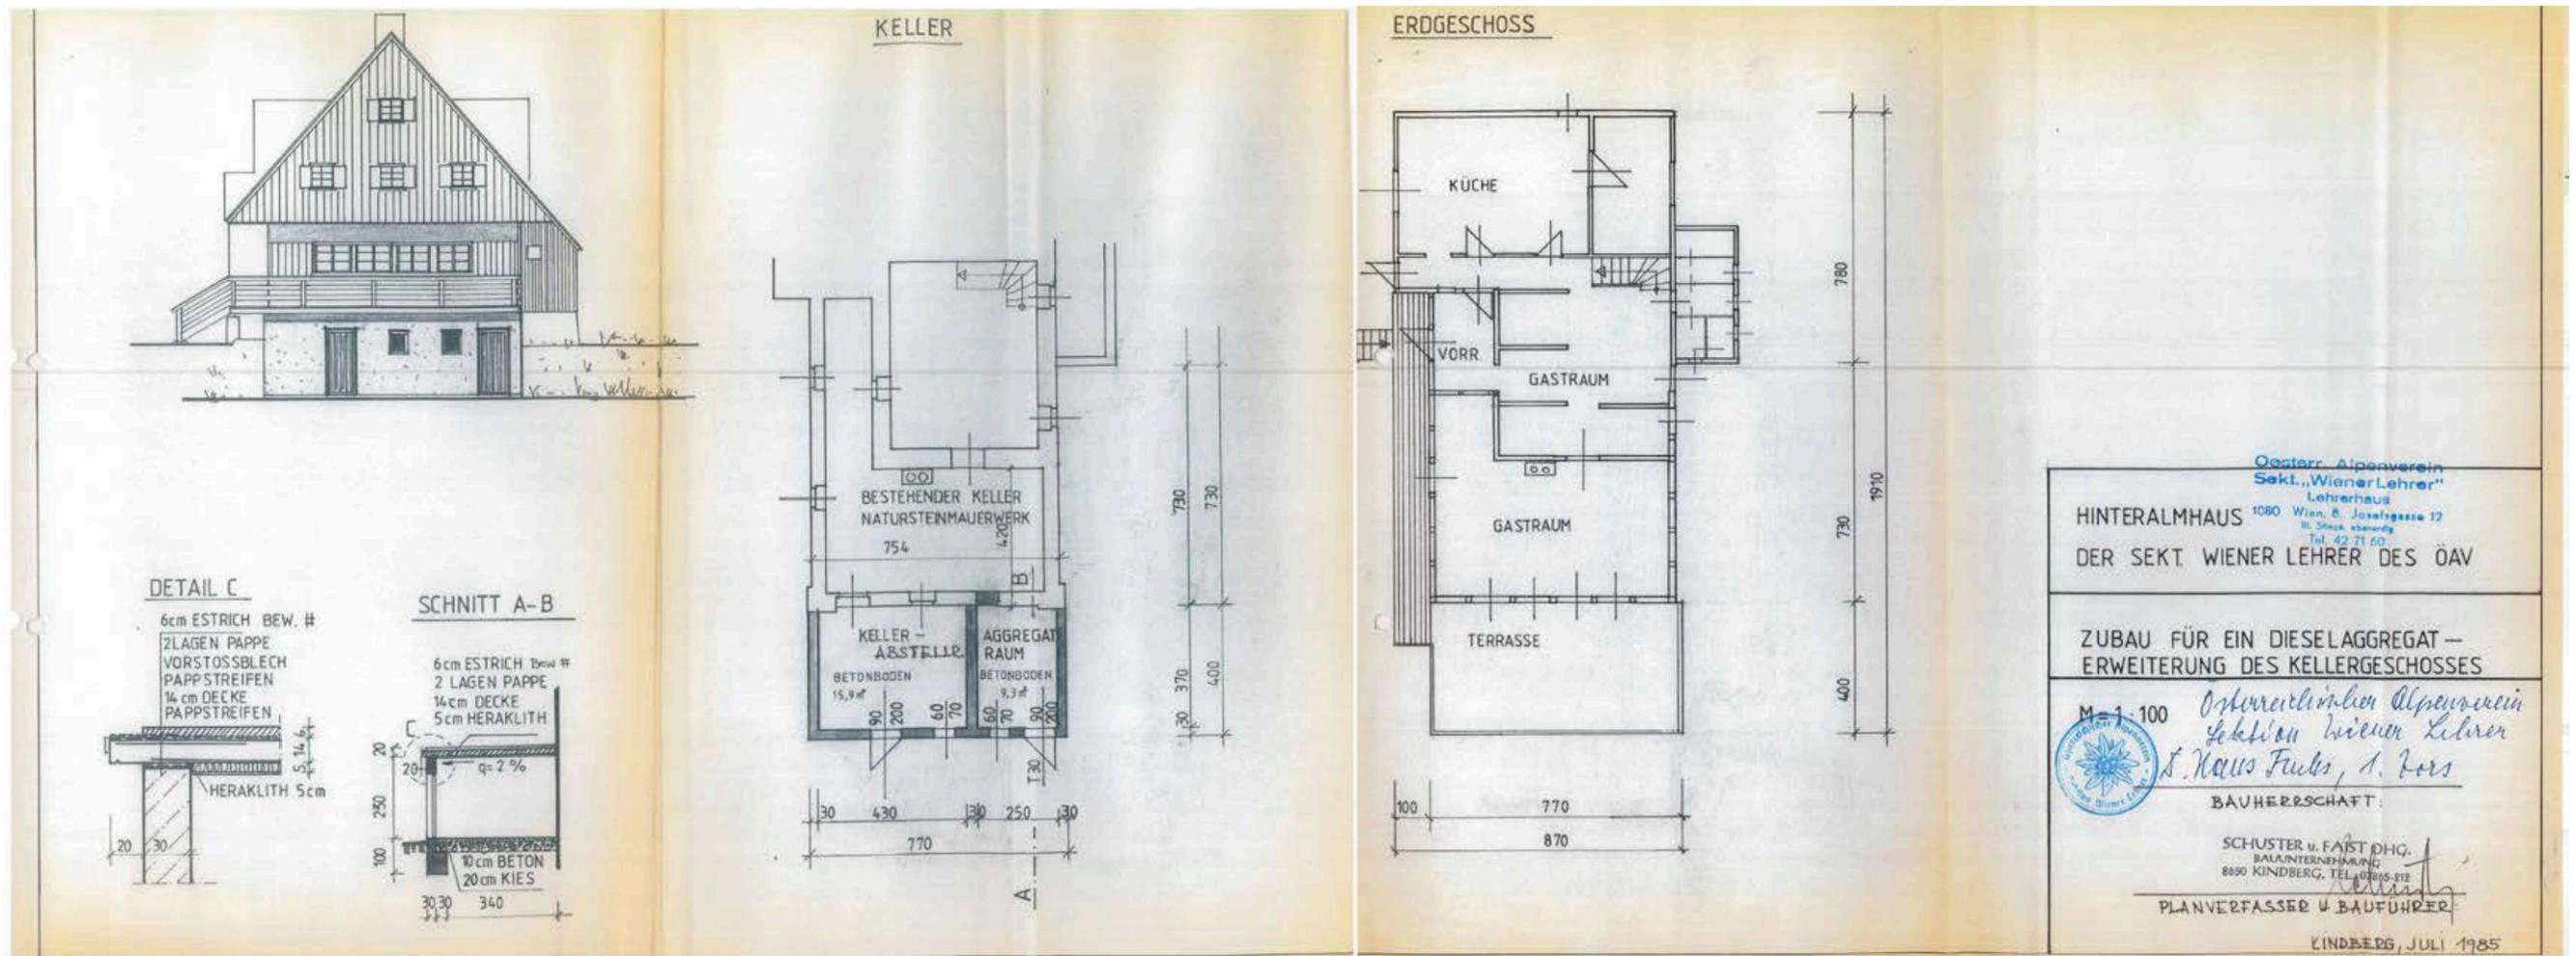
Planunterlagen des ÖAV zum Ausbau 1985
